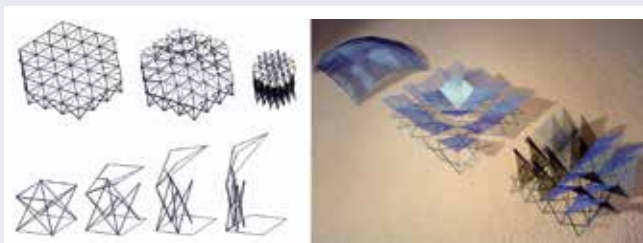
Sistemas de cubiertas desplegables con chapas rígidas.
